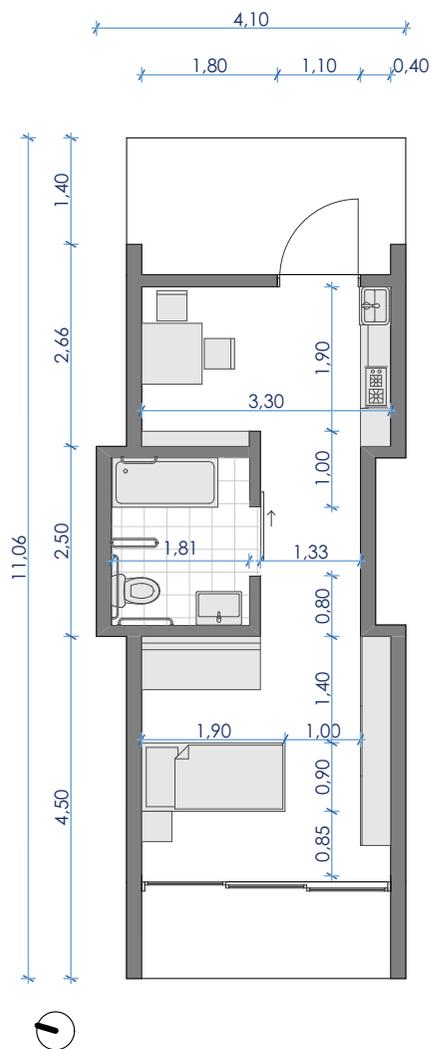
Planta arquitectónica de célula habitacional tipo 1
